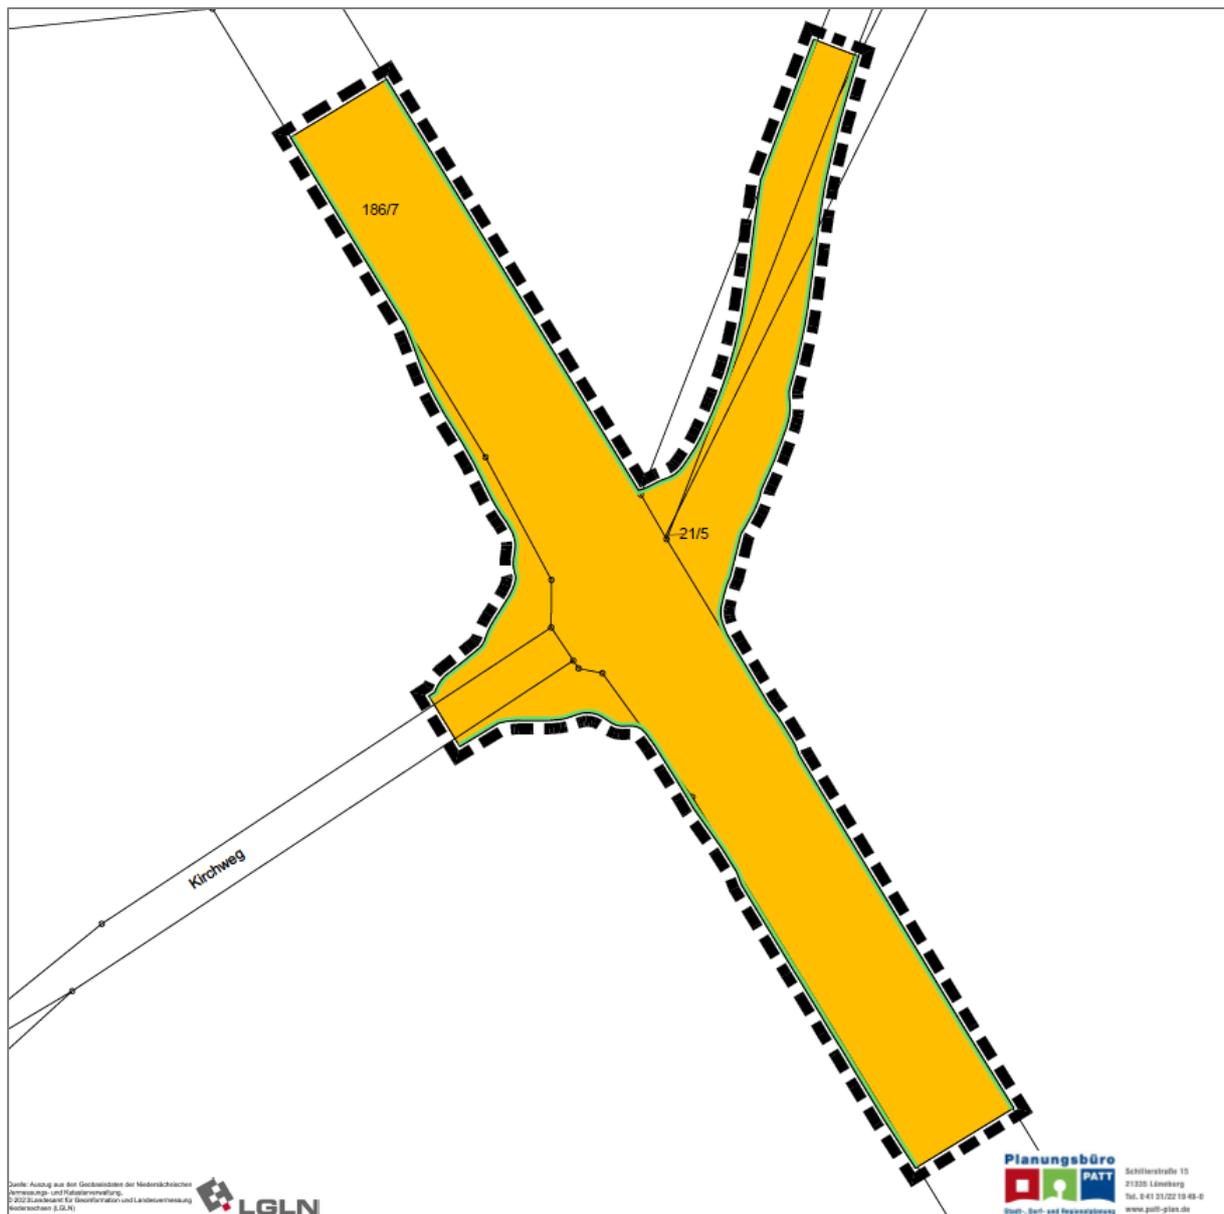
Bebauungsplan, Stand: Vorentwurf, Januar 2023, Quelle: Planungsbüro Patt
